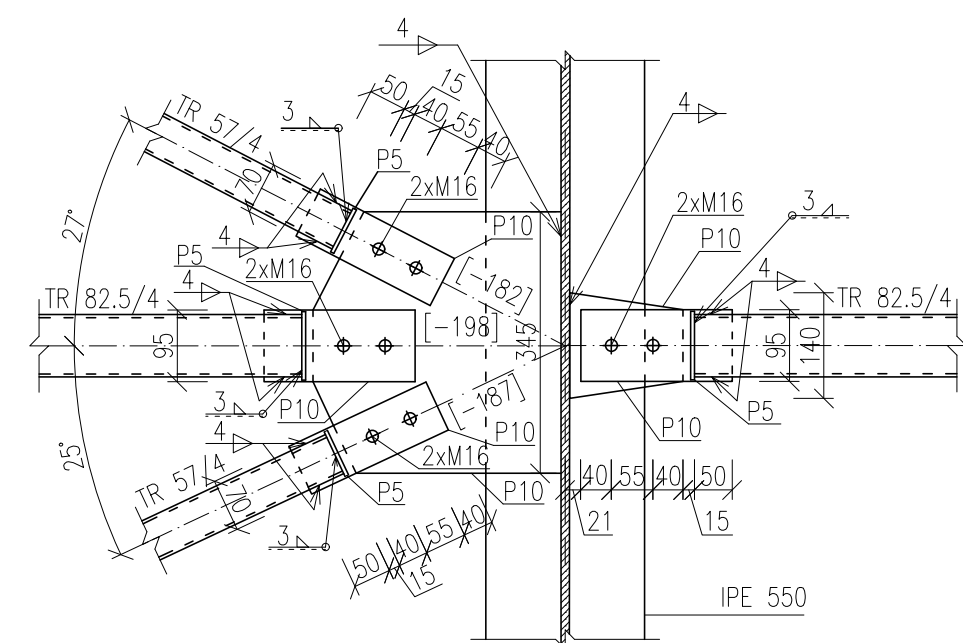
PATKA BĚŽNÉHO SLOUPU
